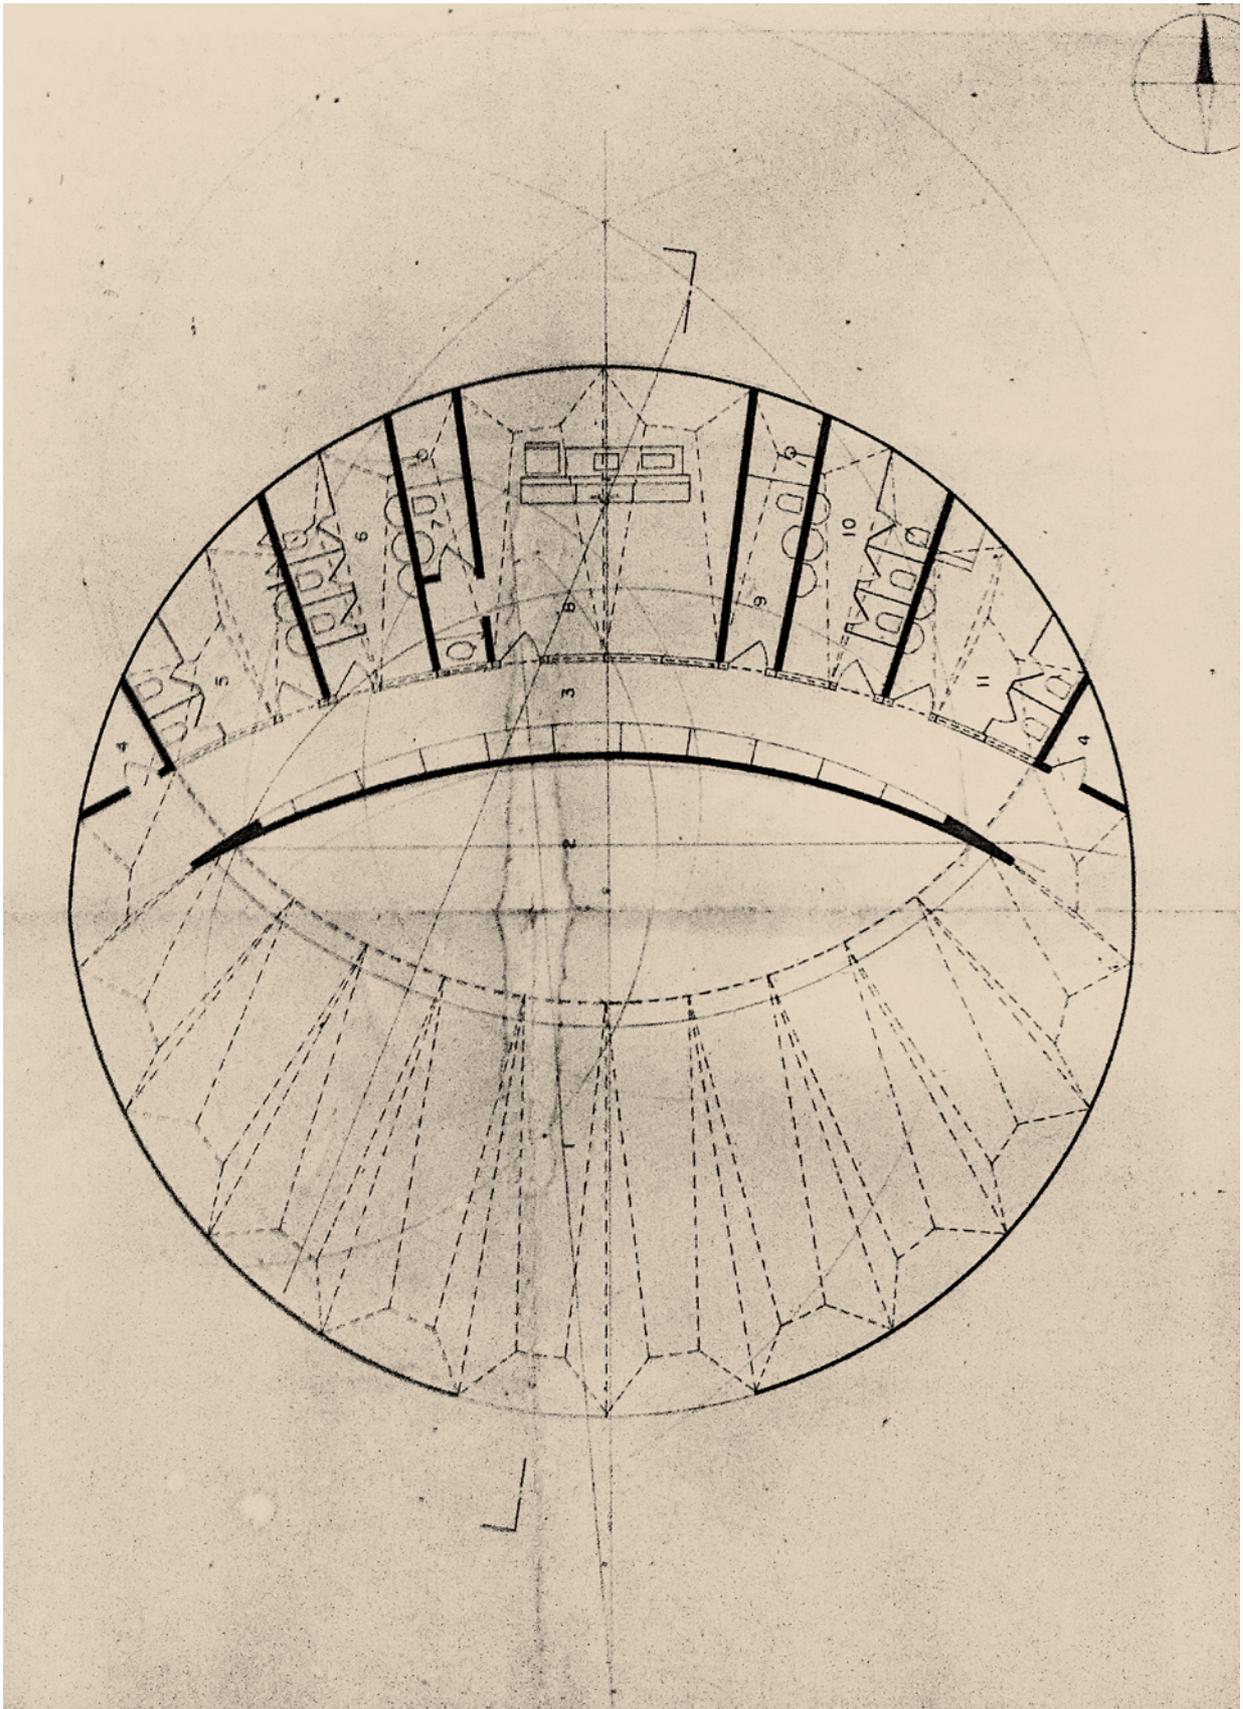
Planta geral do projeto do Pavilhão do Morro da Viúva.
